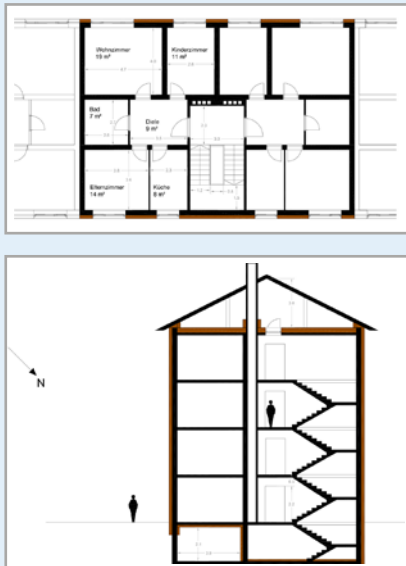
Grundriss und Gebäudeschnitt des Mehrfamilienhauses
